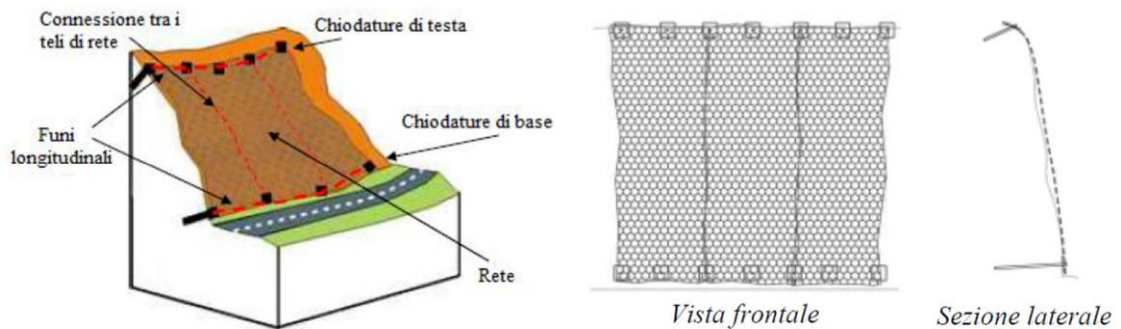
Schema generale, vista frontale ed in sezione di un intervento con Rete semplice.
